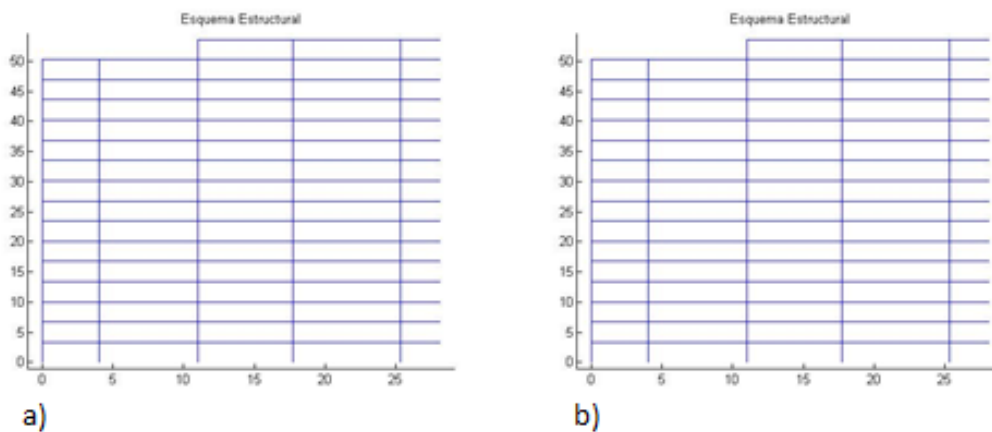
Pórticos transversales sin reforzamiento a) Pórtico 7; b) Pórtico 9.
